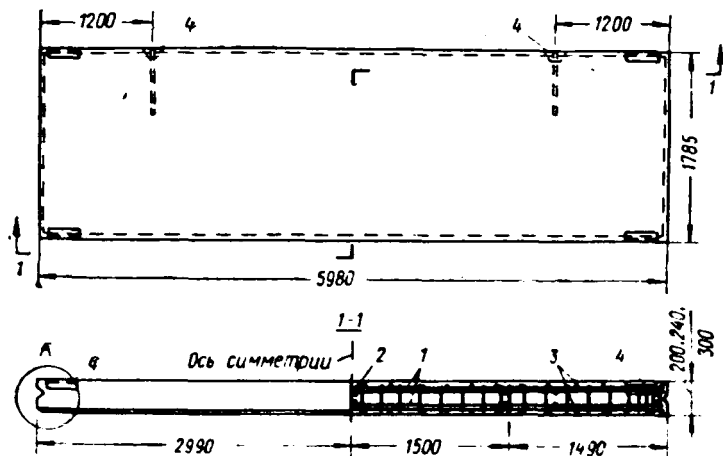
Типовая однослойная стеновая панель длиной 6 м из легкого бетона
